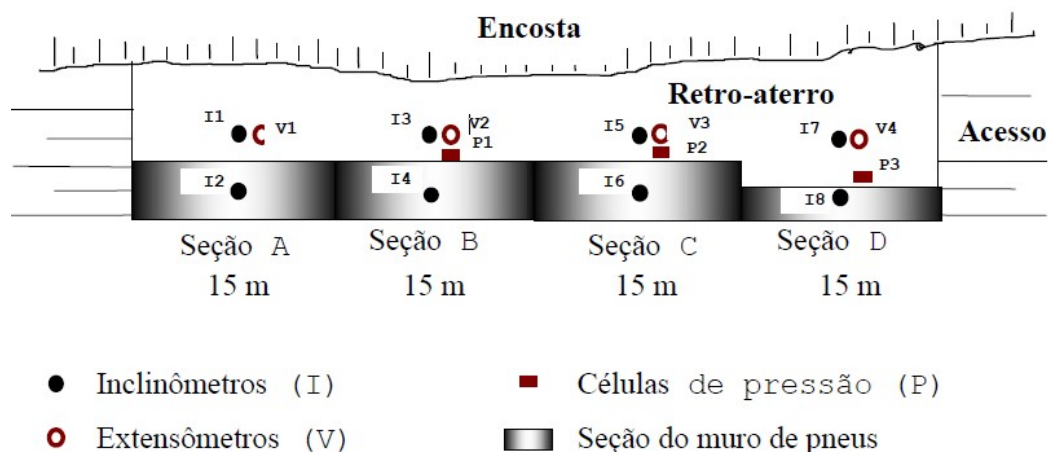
Planta esquemática do muro experimental e da instrumentação de campo (Medeiros et al., 2000).
